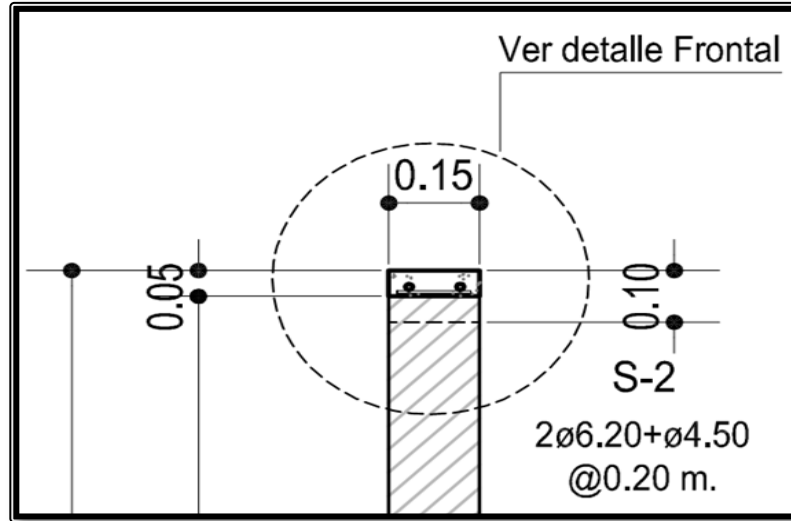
Detalle vista lateral cimiento corrido muros de mampostería.
